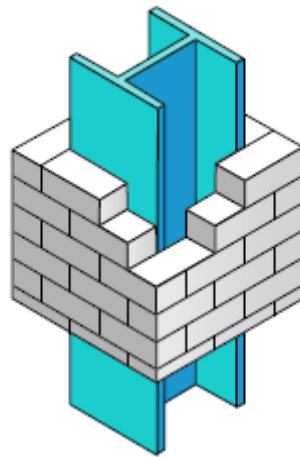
Protection par écran : poteau intègre à la maçonnerie.
